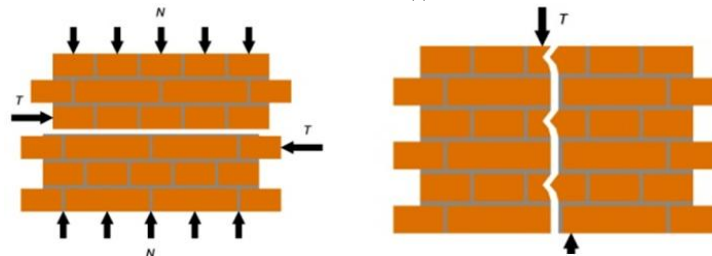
Схема руйнування кам'яної кладки при дії розтяжних зусиль уздовж горизонтальних швів кладки
